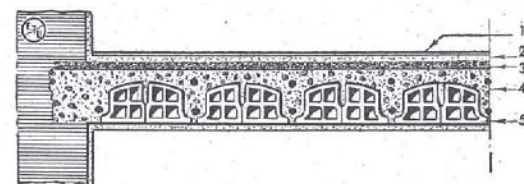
SOLAIO "MIOZZO SALERNI", - 1 Pavimento - 2 Lastre isolanti - 3 Sottofondo - 4 Gettata in calcestruzzo di cemento - 5 Foraloni in laterizio.
